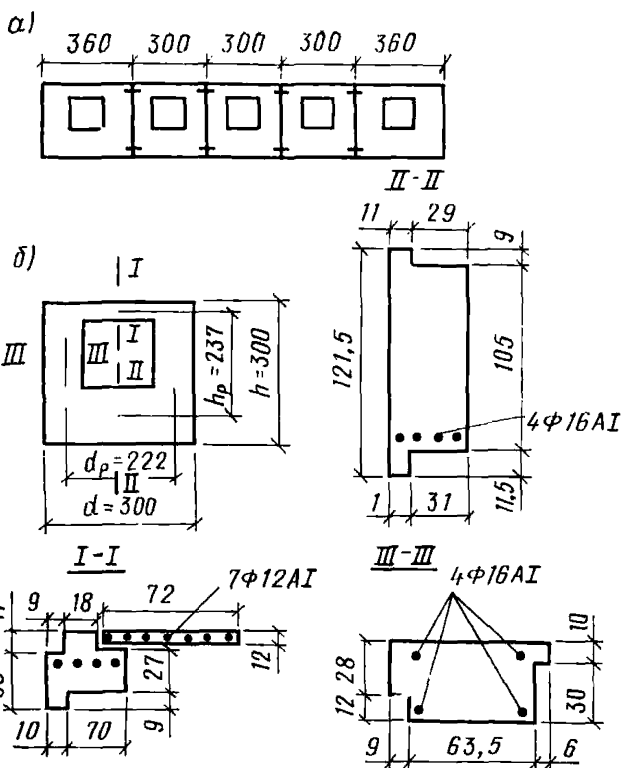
К определению сдвиговой жесткости элементов наружной продольной стены
